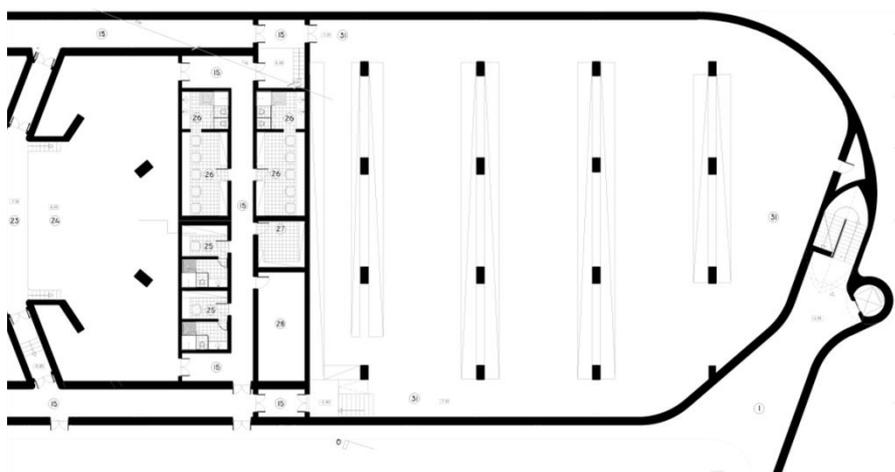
Pormenor da planta da Cave do Museu, e parte dos corredores para o grande armazém.
